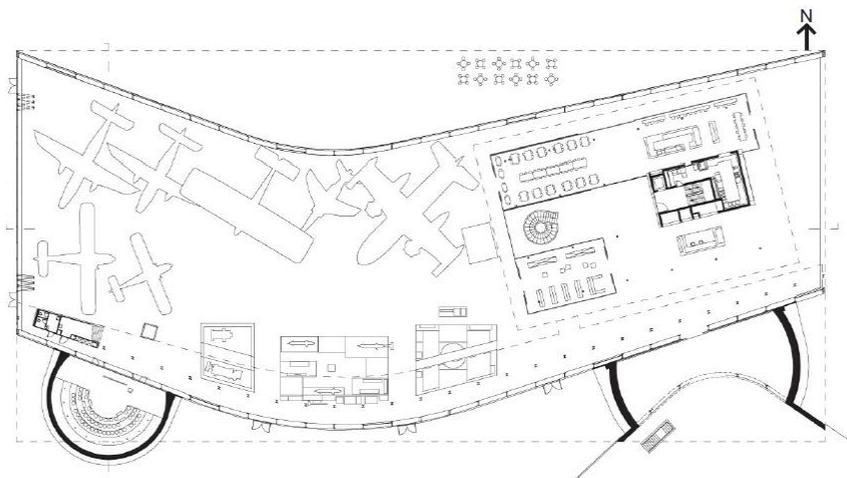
Planta baixa. FUENTE: <http://www.archdaily.com/374418/dornier-museum-allmann-sattler-wappner-architekten/> Consultado el: 18 mai 2014.
